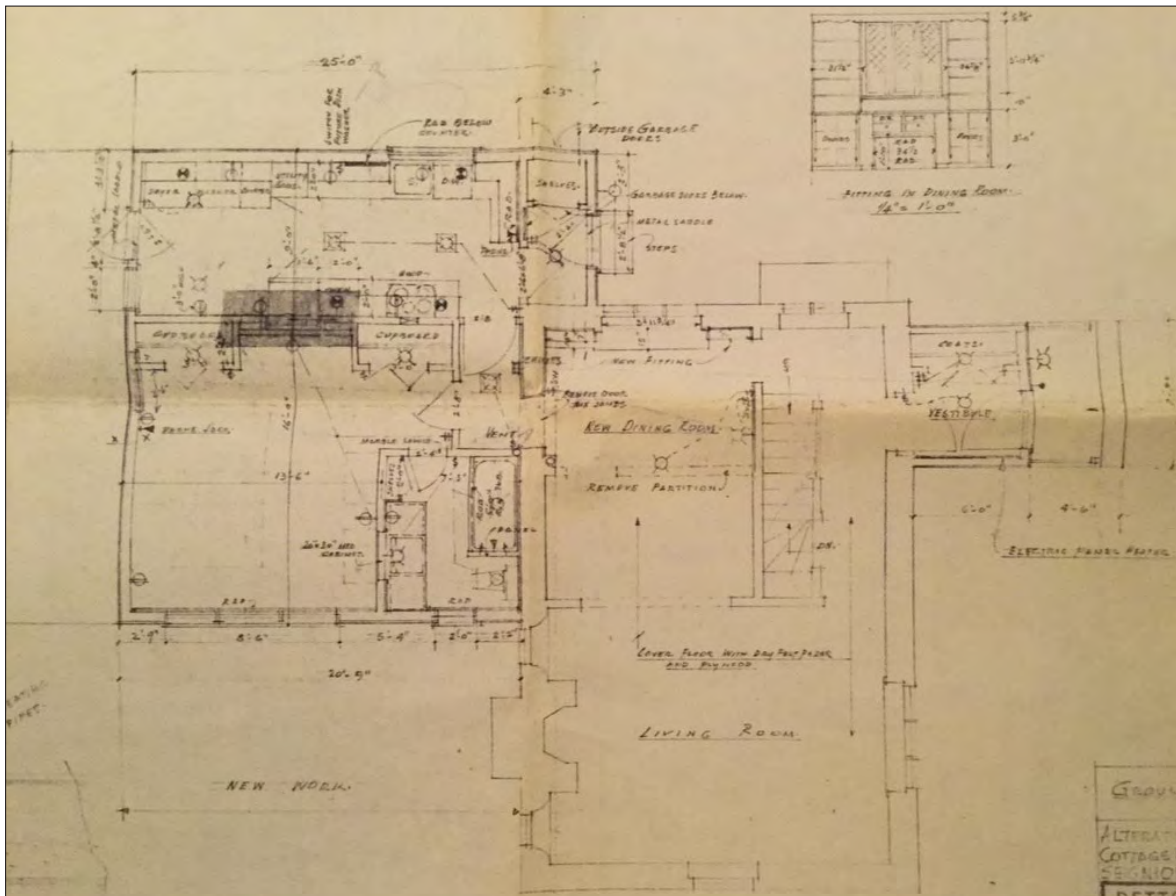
Plan de construction de la nouvelle annexe, 1965. Source : Archives Fairmont Château Montebello.
